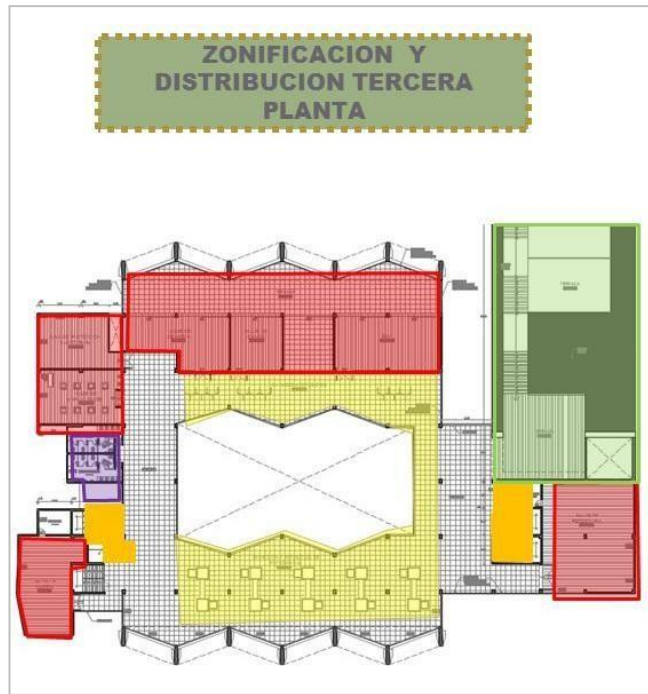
distribución tercera planta de la propuesta arquitectónica.
